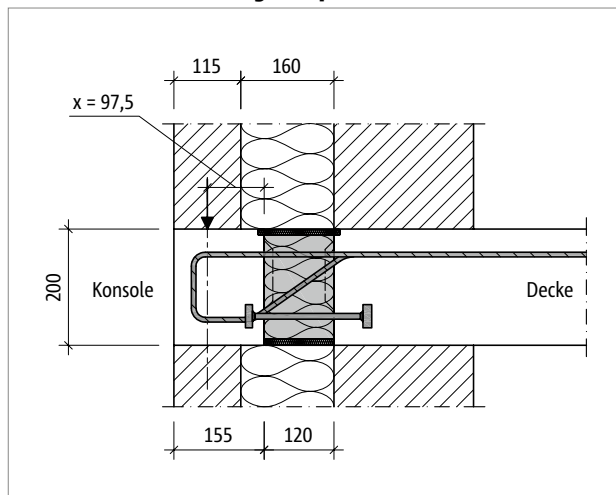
Schöck Isokorb® XT Typ O: Wandaufbau für Bemessungsbeispiel
